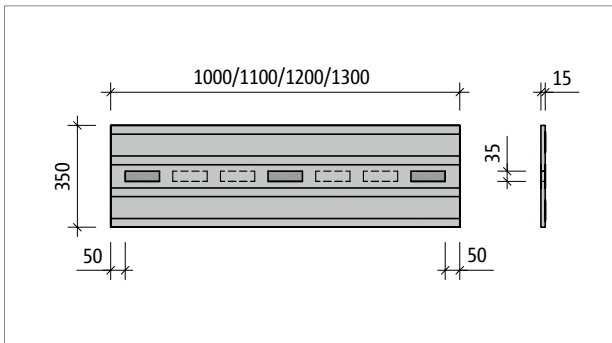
Schöck Tronsole® Typ B-V1...-B350: Produktgrundriss
